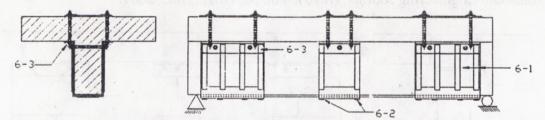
مسقط أفقي وقطاع في كمرة أثناء الضغد عليها في الاتجاهين الأفقي والرأسي
